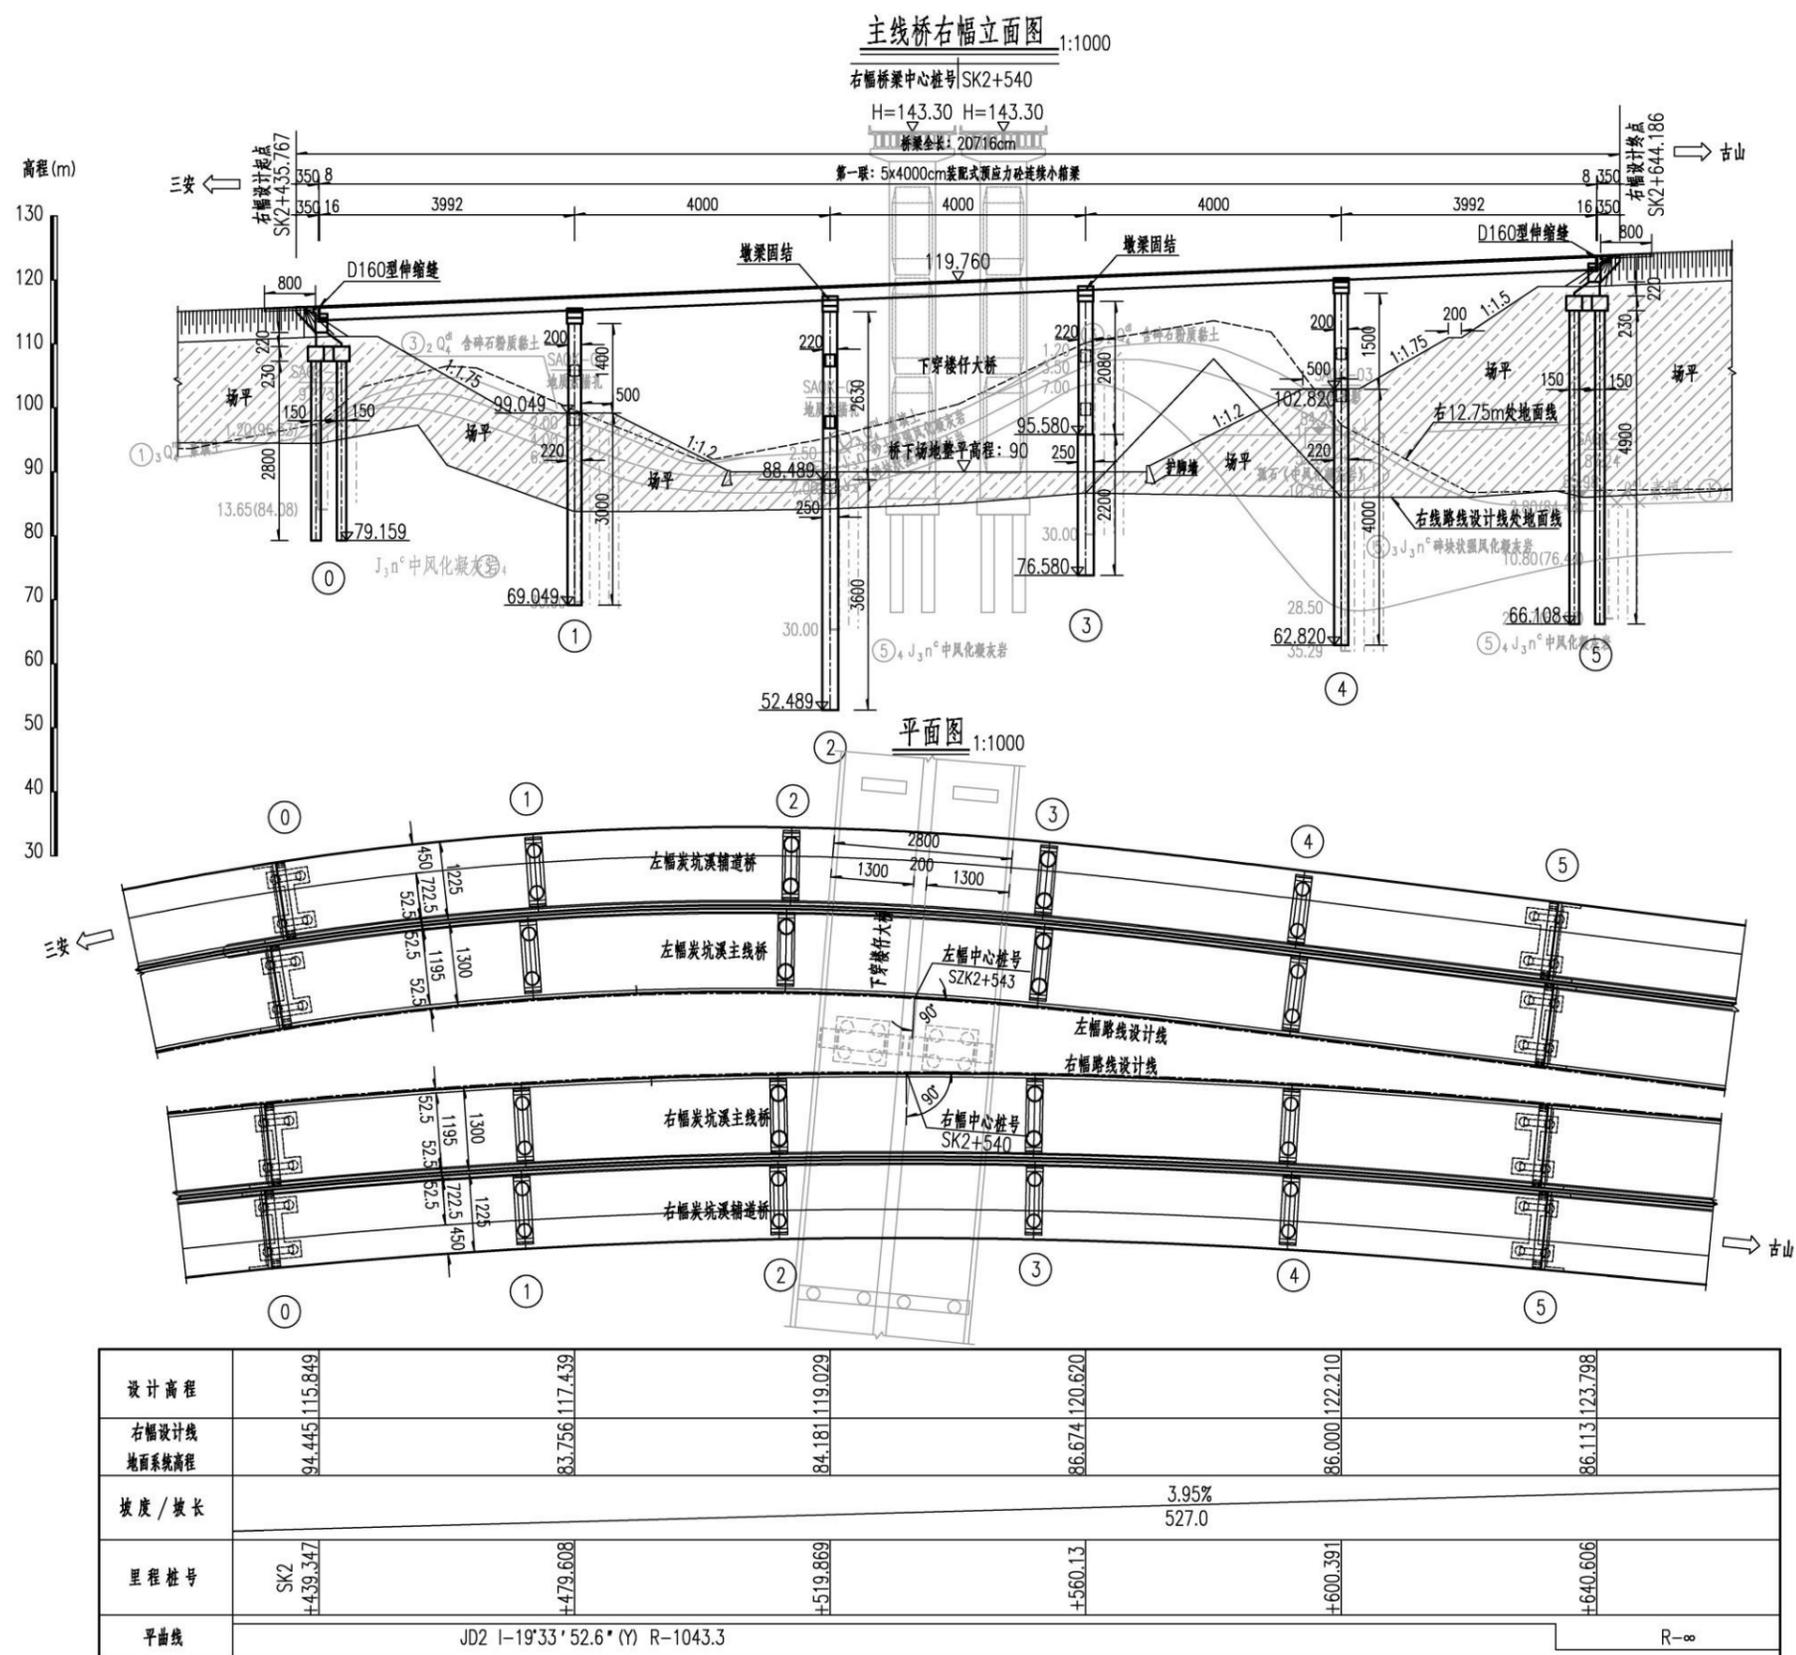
本项目炭坑溪大桥主线桥右幅立面图
